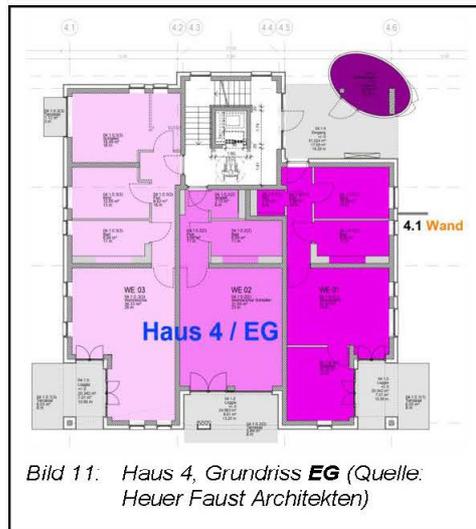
Haus 4, Grundriss EG (Quelle: Heuer Faust Architekten)
